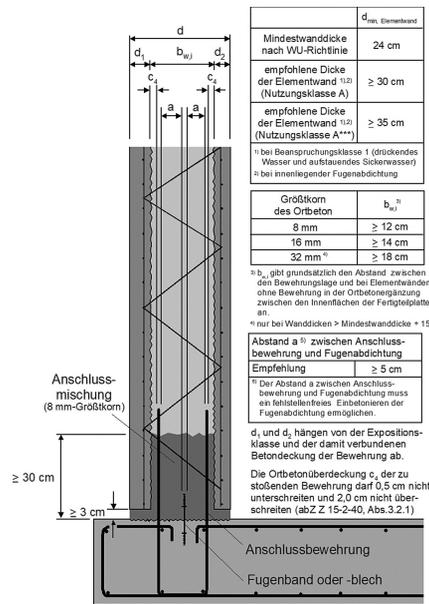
Maße und Abstände beim Bauen mit Elementwänden
